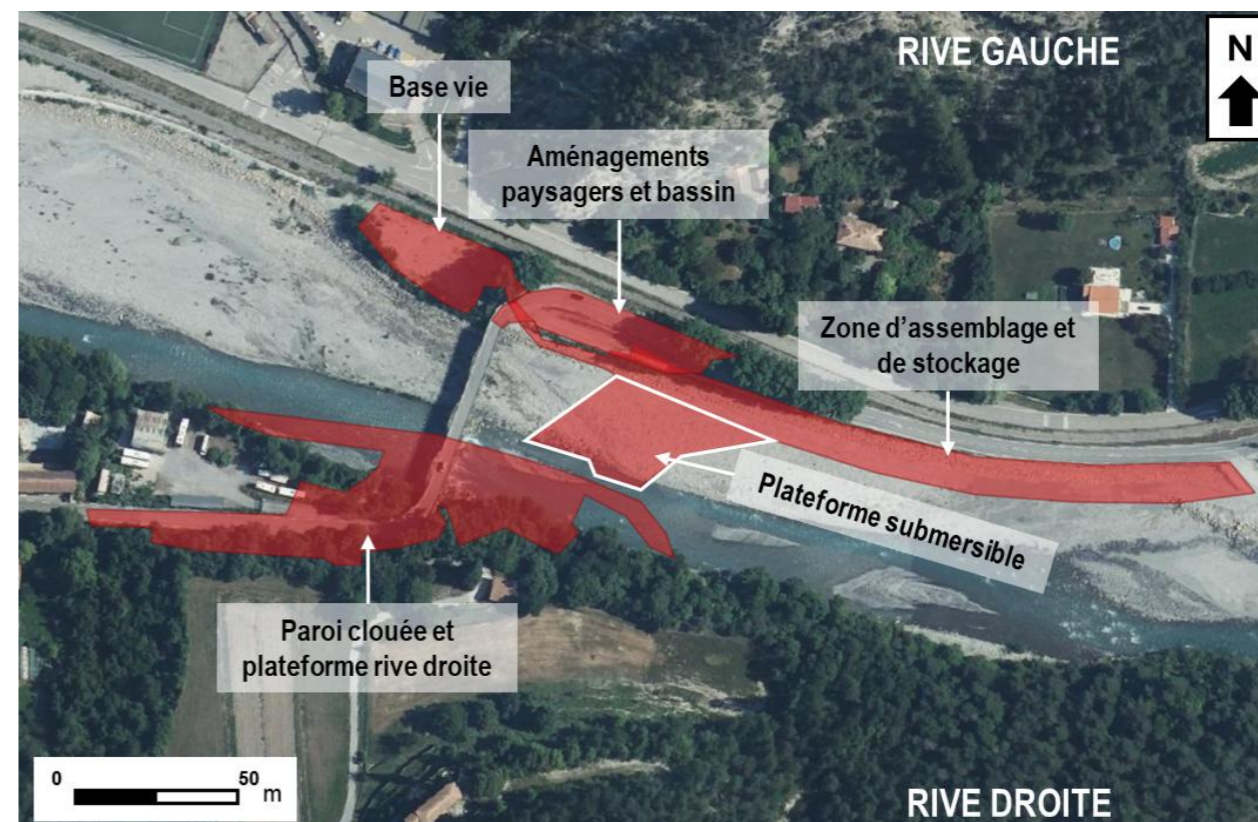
Emprise des travaux de la phase de construction sans la surface de dérivation
